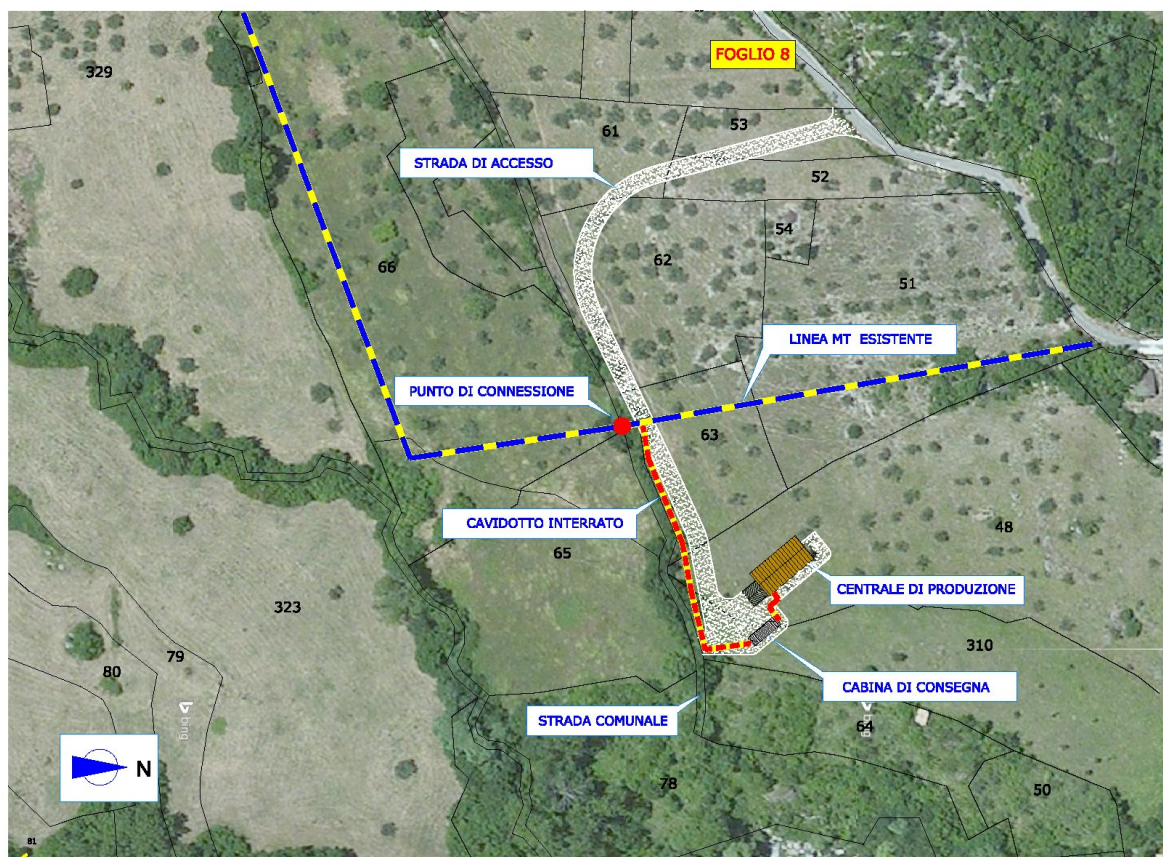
Planimetria su ortofoto delle opere di connessione alla rete
